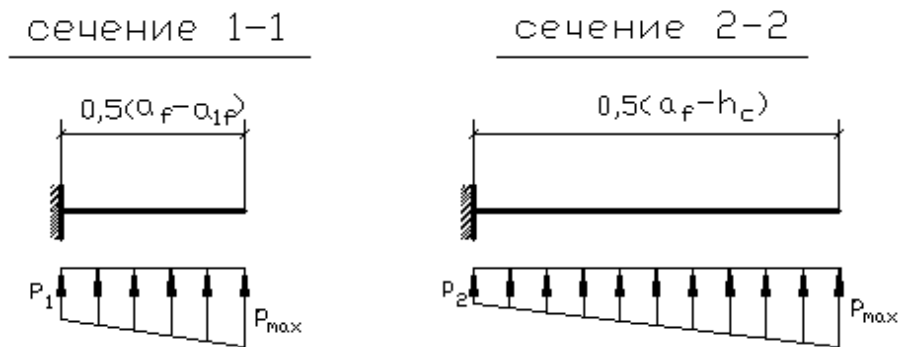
Расчетные схемы вылетов ступеней фундамента
